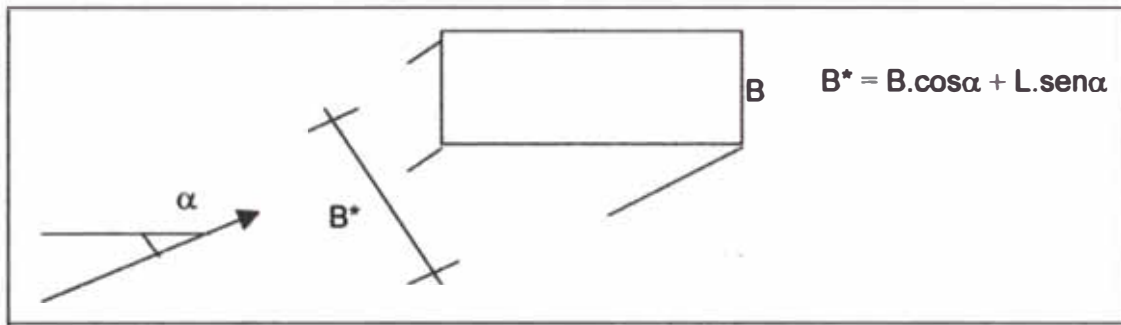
ancho proyectado para el cálculo de la erosión local
